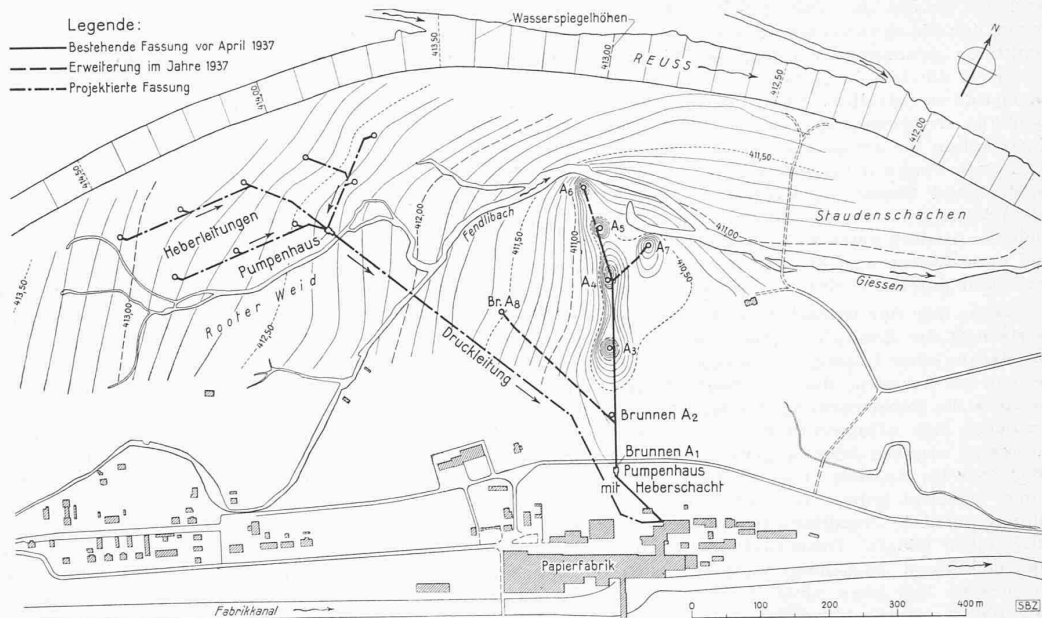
Grundwasserversorgung der Papierfabrik Perlen. Lageplan 1: 10000 mit Betriebswasserspiegel bei voller Beanspruchung der bestehenden Grundwasser-Fassung (nach der Erweiterung von 1937)
